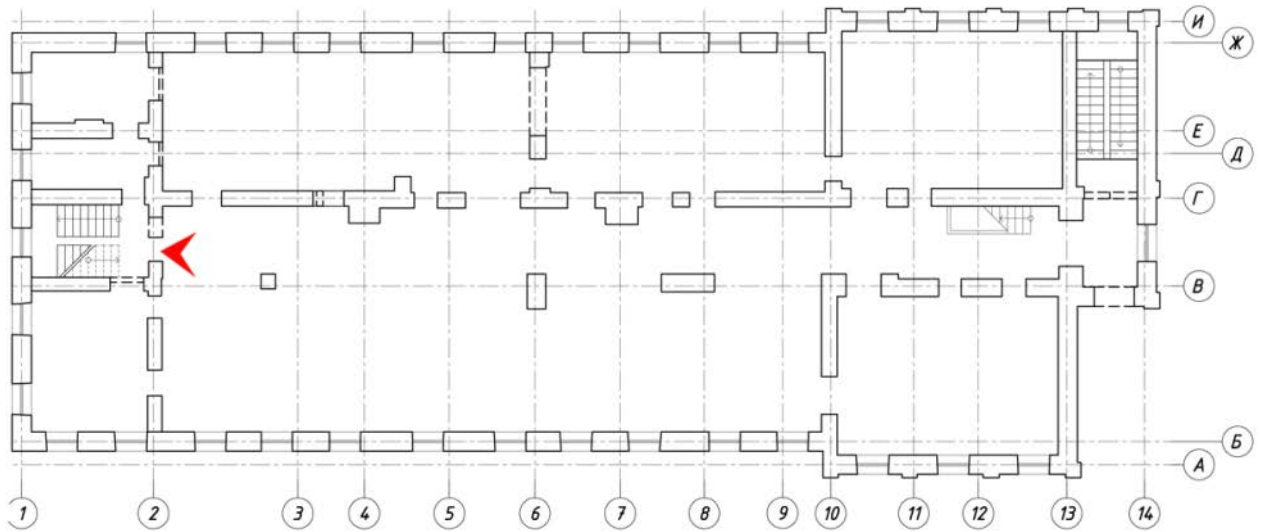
Зальное помещение 2-го этажа в осях 2 – 10/А – Г.
